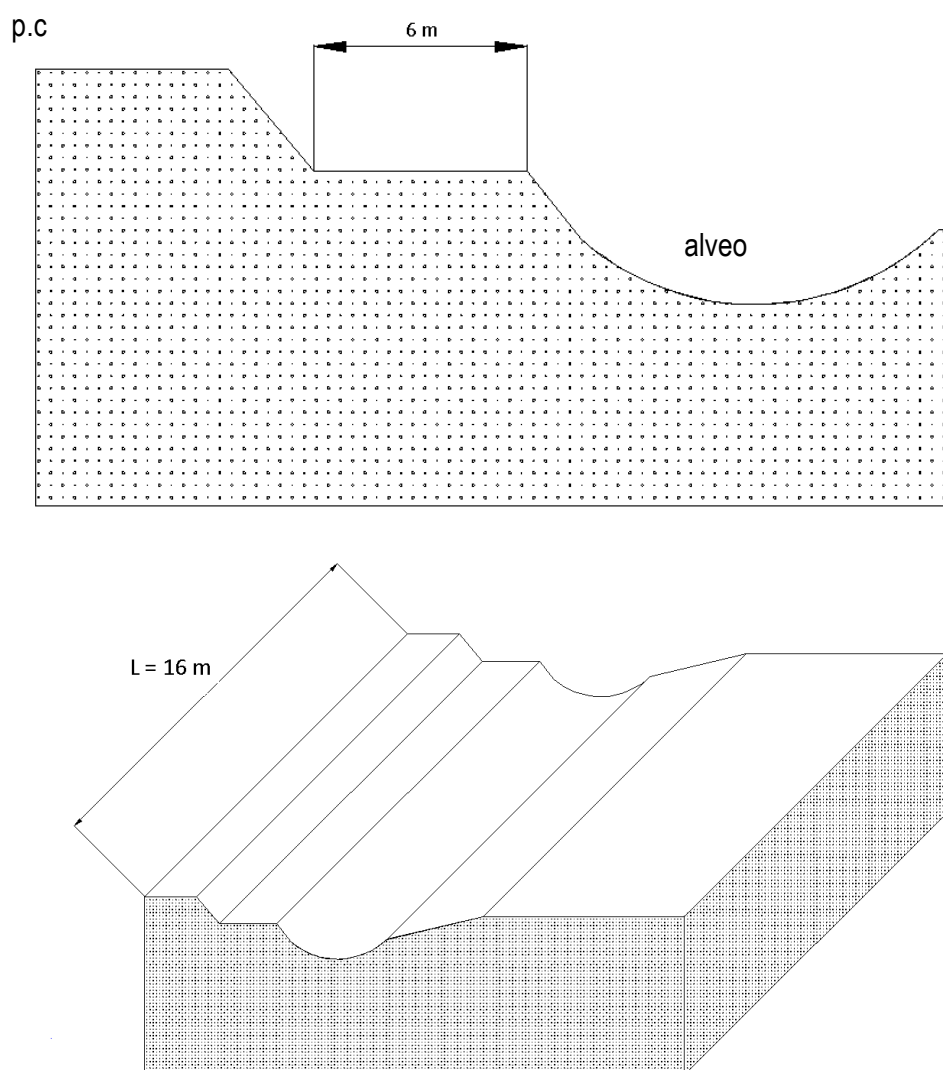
Pianta (in basso) e sezione trasversale (in alto) dell'area relativa all'Intervento 7
